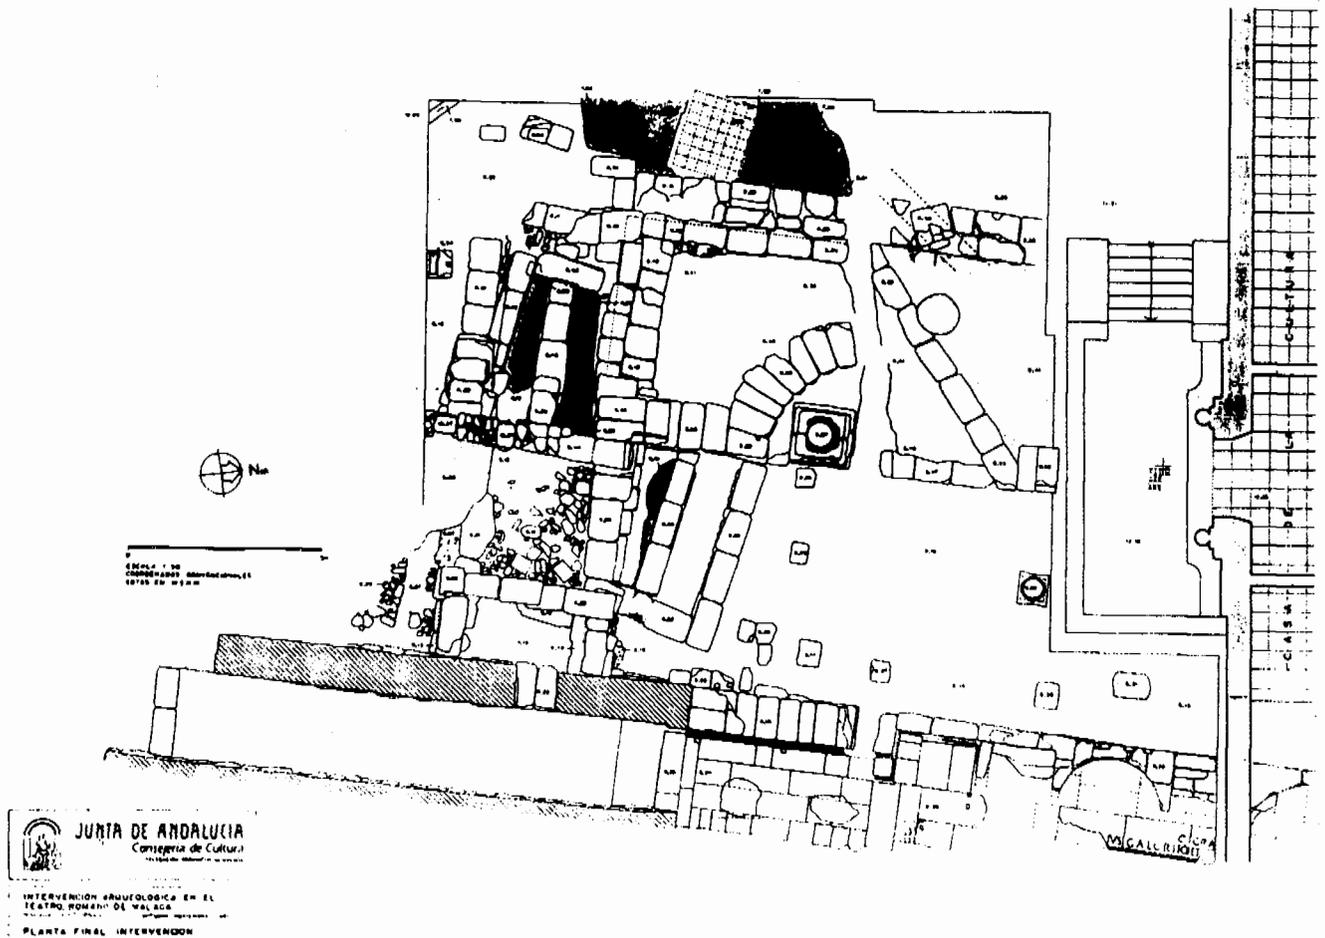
Planta de las termas republicanas (rayado) bajo la scaena del teatro de Málaga.
